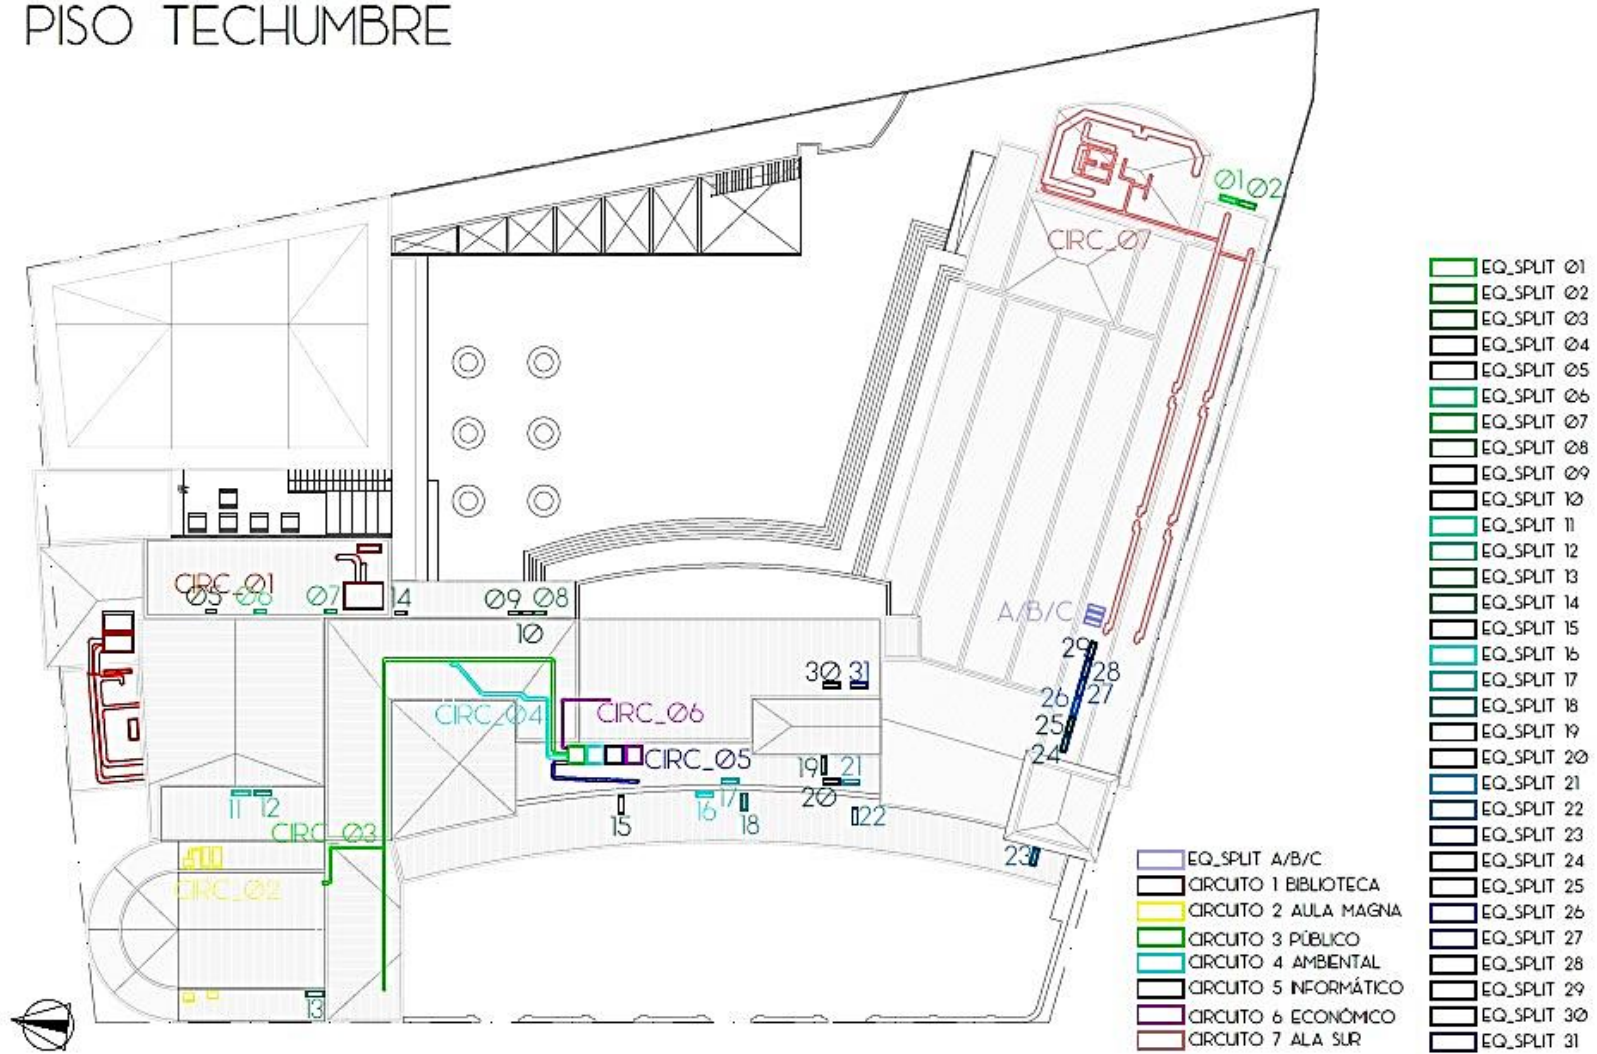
Planta esquema sistemas de aire acondicionado, niveles de techumbre.
